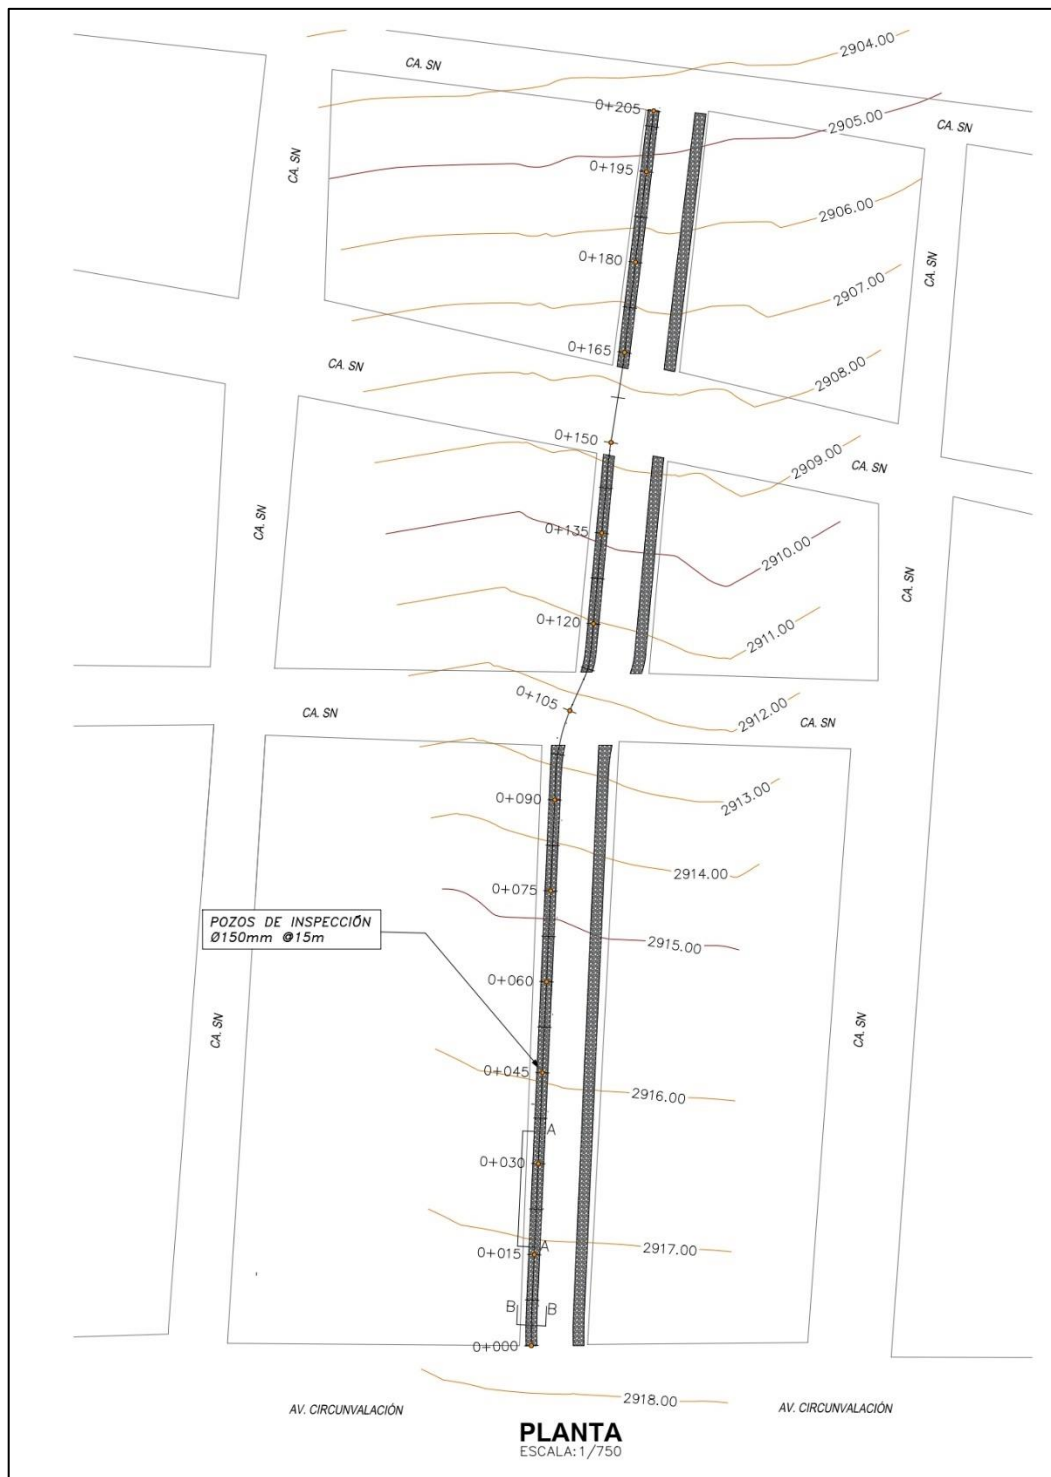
Planta de la zanja de infiltración (IFT 04)
